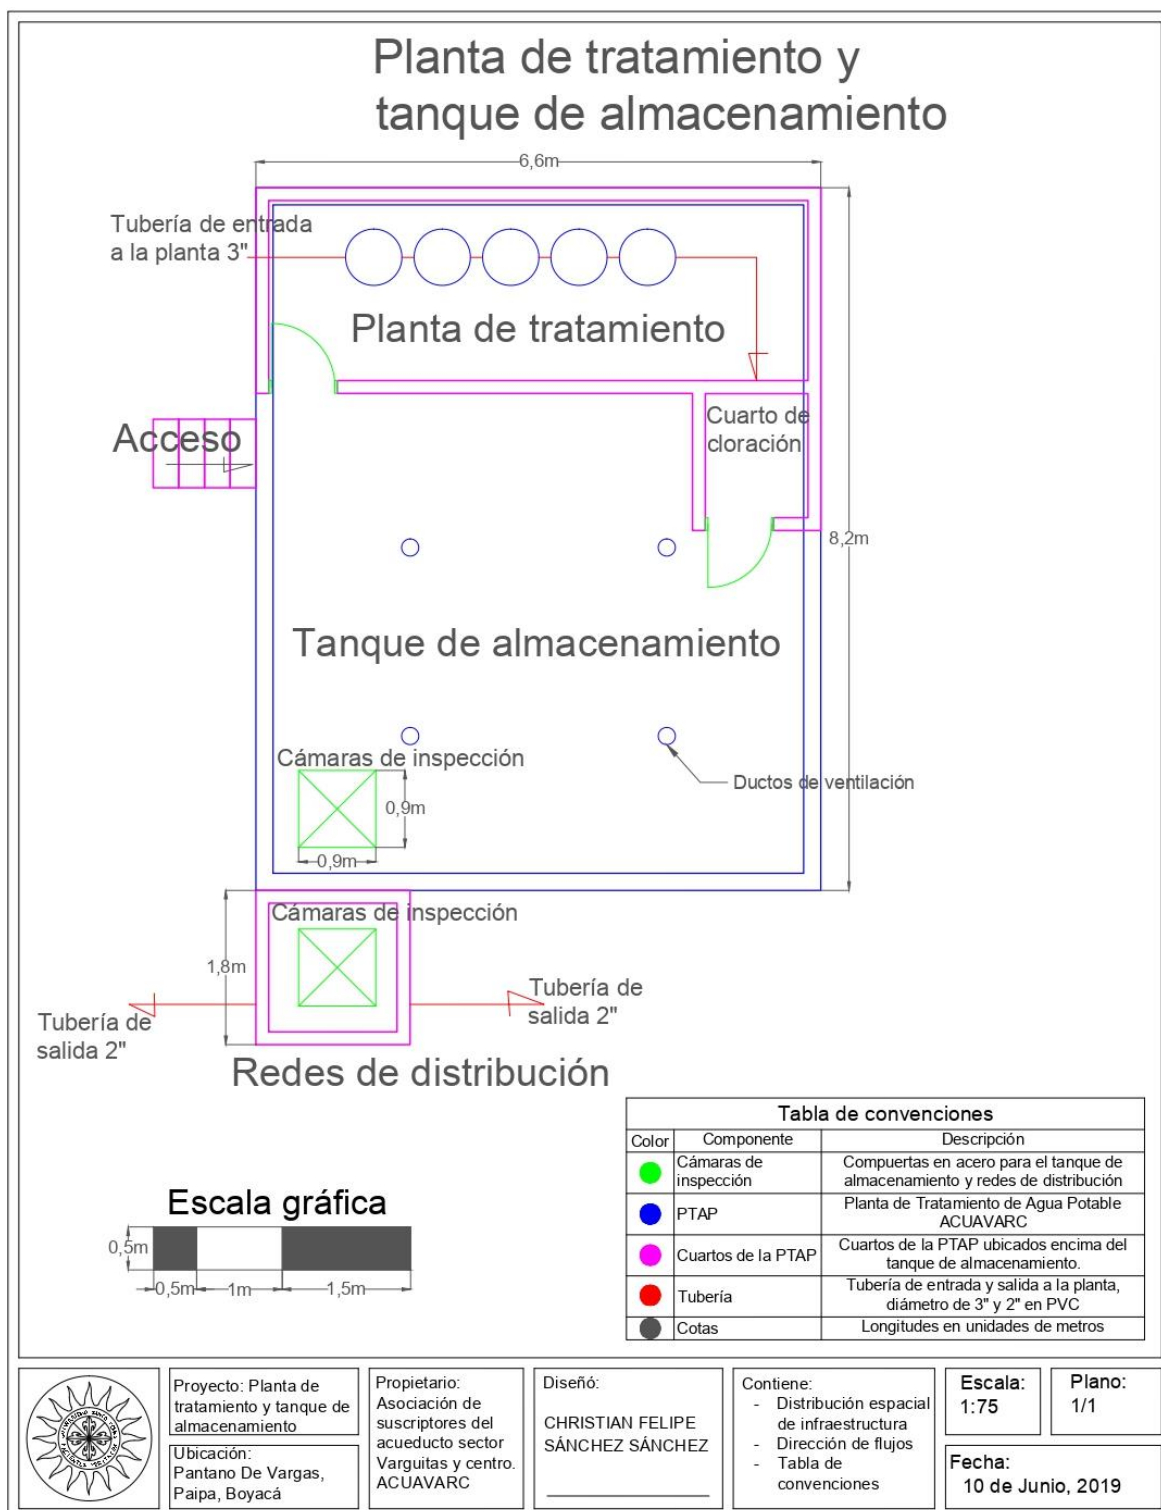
Plano de planta de tratamiento y tanque de almacenamiento
